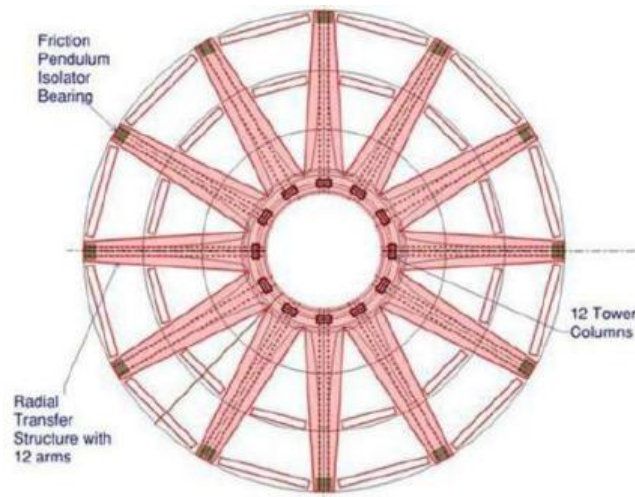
Vigas de transferencia radiales y concepto preliminar de aislamiento en la base, NAICM
